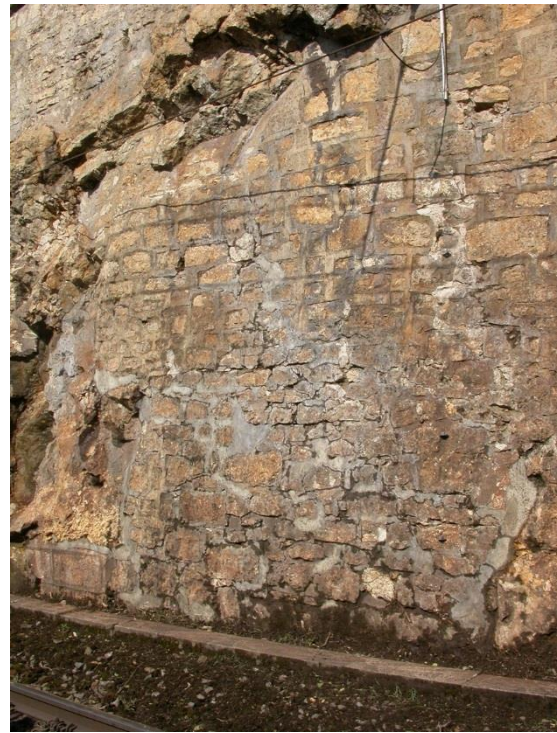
Joints détériorés localement, mortier terreux-sableux
